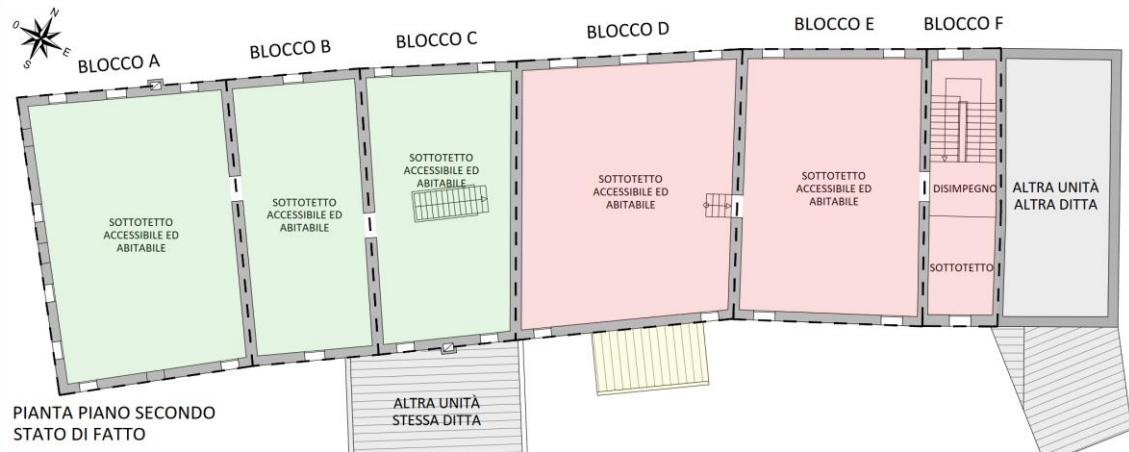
Pianta piano secondo - Stato di fatto – scala generica
